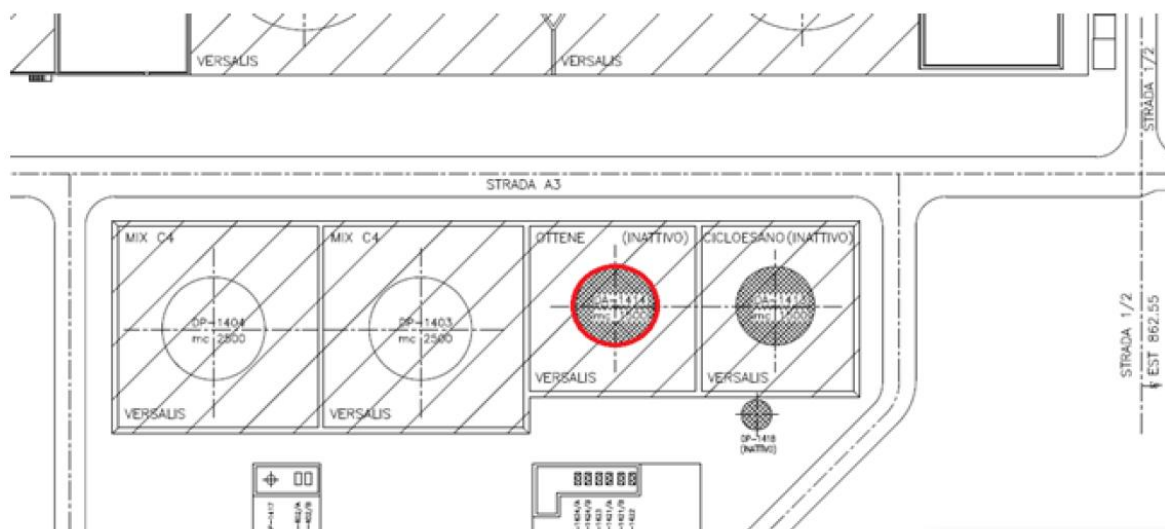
Stralcio planimetrico del serbatoio DA-1417 in area SG11
